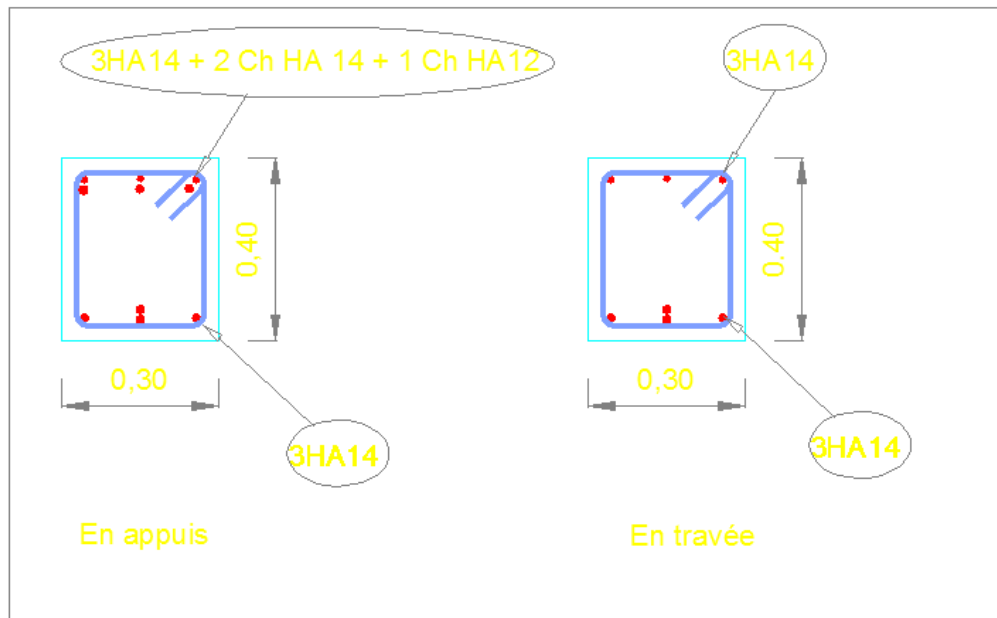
Ferrailage poutre principale 5<sup>eme</sup> et 4<sup>eme</sup> étage
